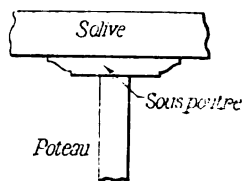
Poteau en bois avec sous-poutre soulageant une poutre.
